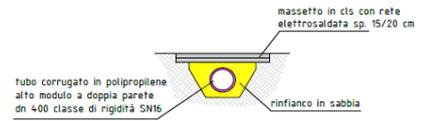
Tipologia di attraversamento stradale e cavalcafosso in progetto
